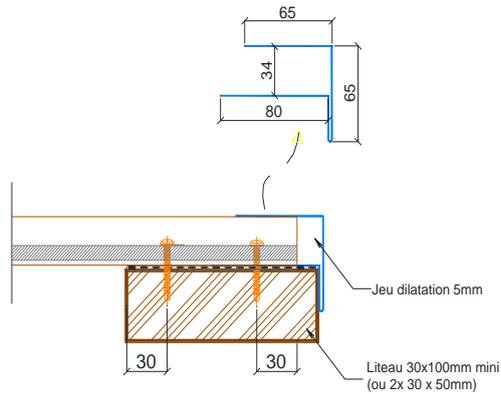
Coupe horizontale sur arrêt latéral sur OB en pose horizontale
